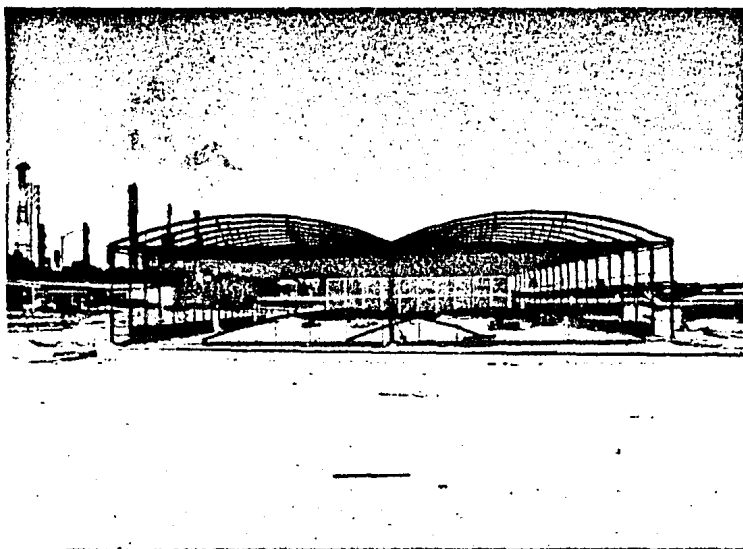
Estructura Metálica de Almacenes a Cubierta
